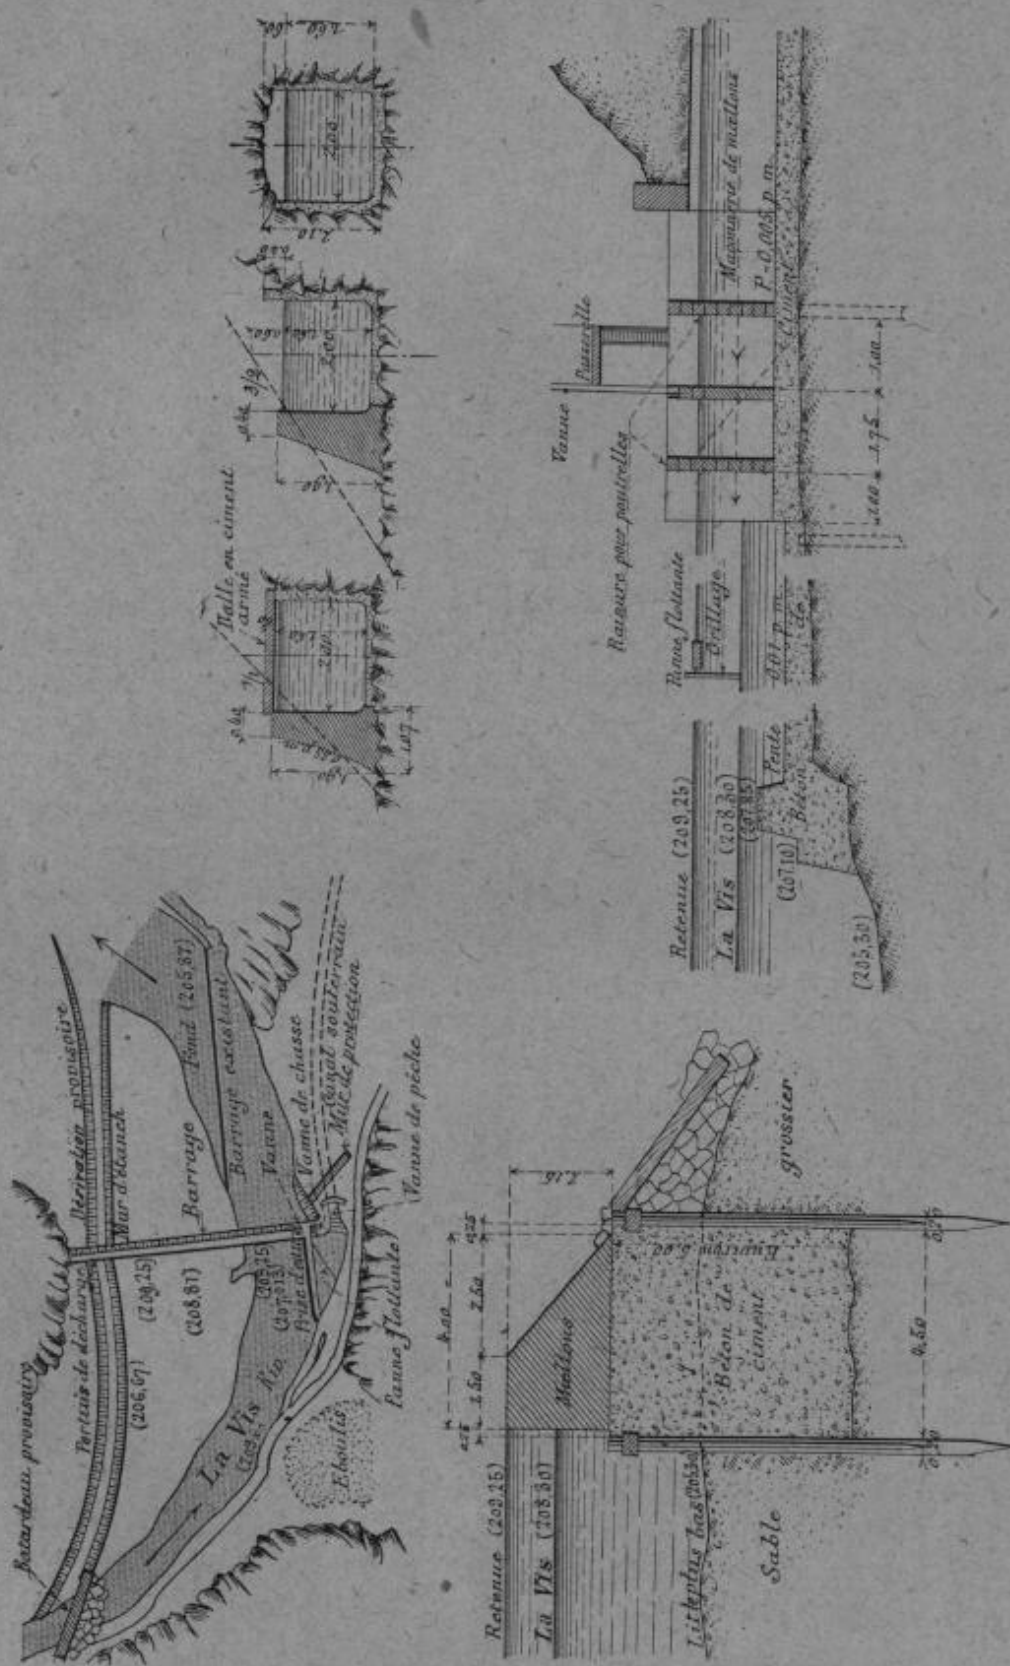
Usine de Madières. Plan d'ensemble des ouvrages de la prise d'eau. Coupe transversale du barrage et coupe longitudinale du canal de dérivation.
